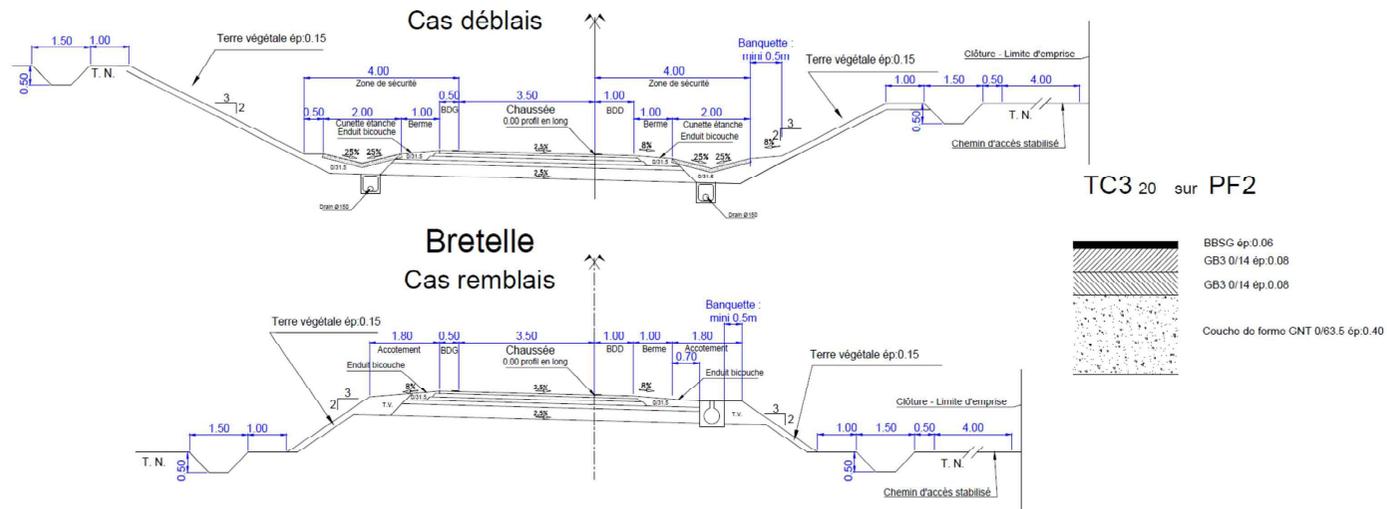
PROFIL EN TRAVERS BRETELLE (SOURCE : ÉTUDE PRO)
